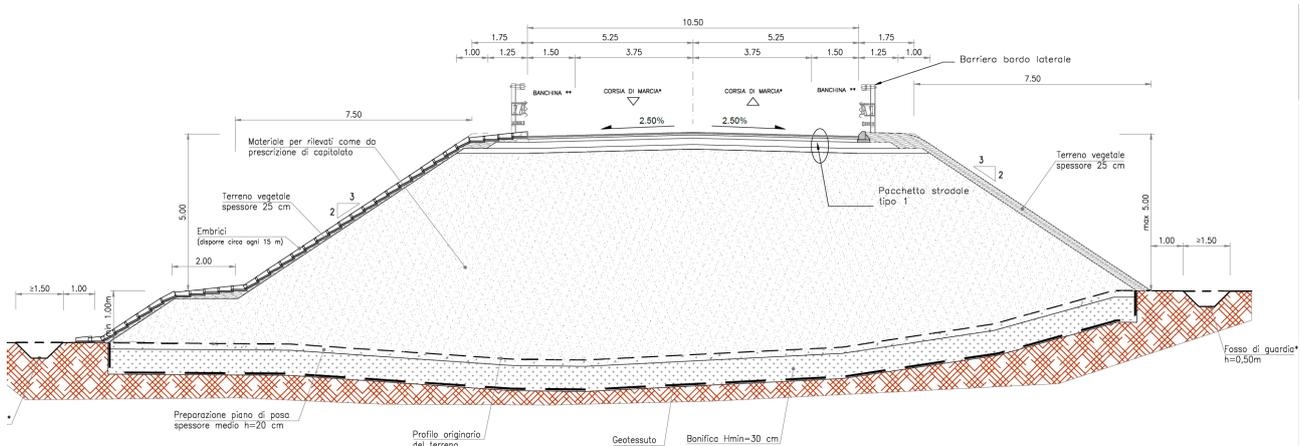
Sezione Tipo Asse Principale in rettilineo
